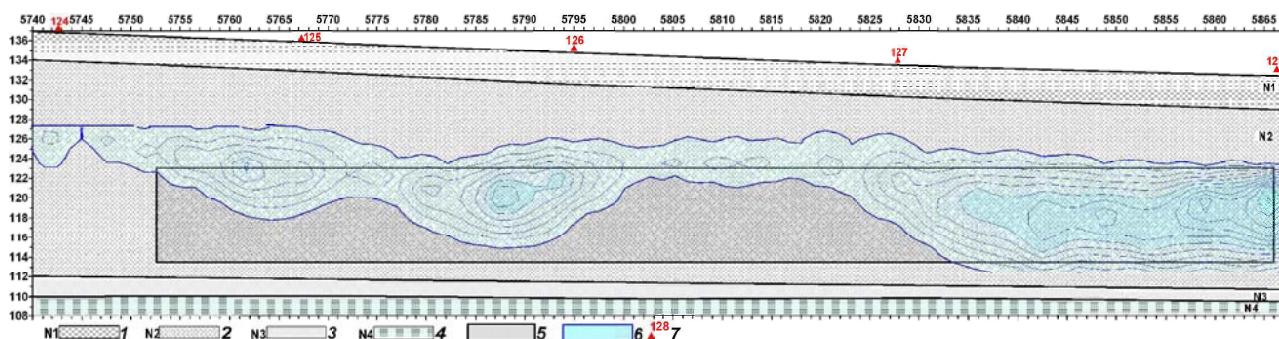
Геолого-геофизический разрез вдоль здания № 1 в районе строительства станции метро “Голосеевская” (профиль 1): 1 – насыпной грунт; 2 – суглинки и супеси; 3 – суглиники; 4 – глины; 5 – зона нагнетания цементирующих растворов; 6 – зона повышенного увлажнения и повышенной фильтрации грунтовых вод; 7 – геодезический репер
